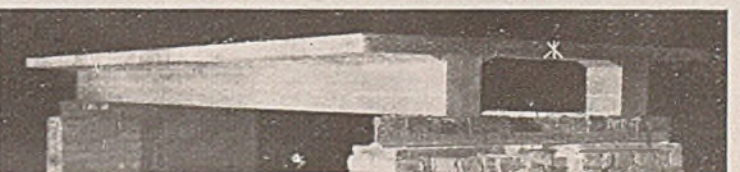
Ausgeschaltete Versuchsdecke im Alter von 47 Stunden.
